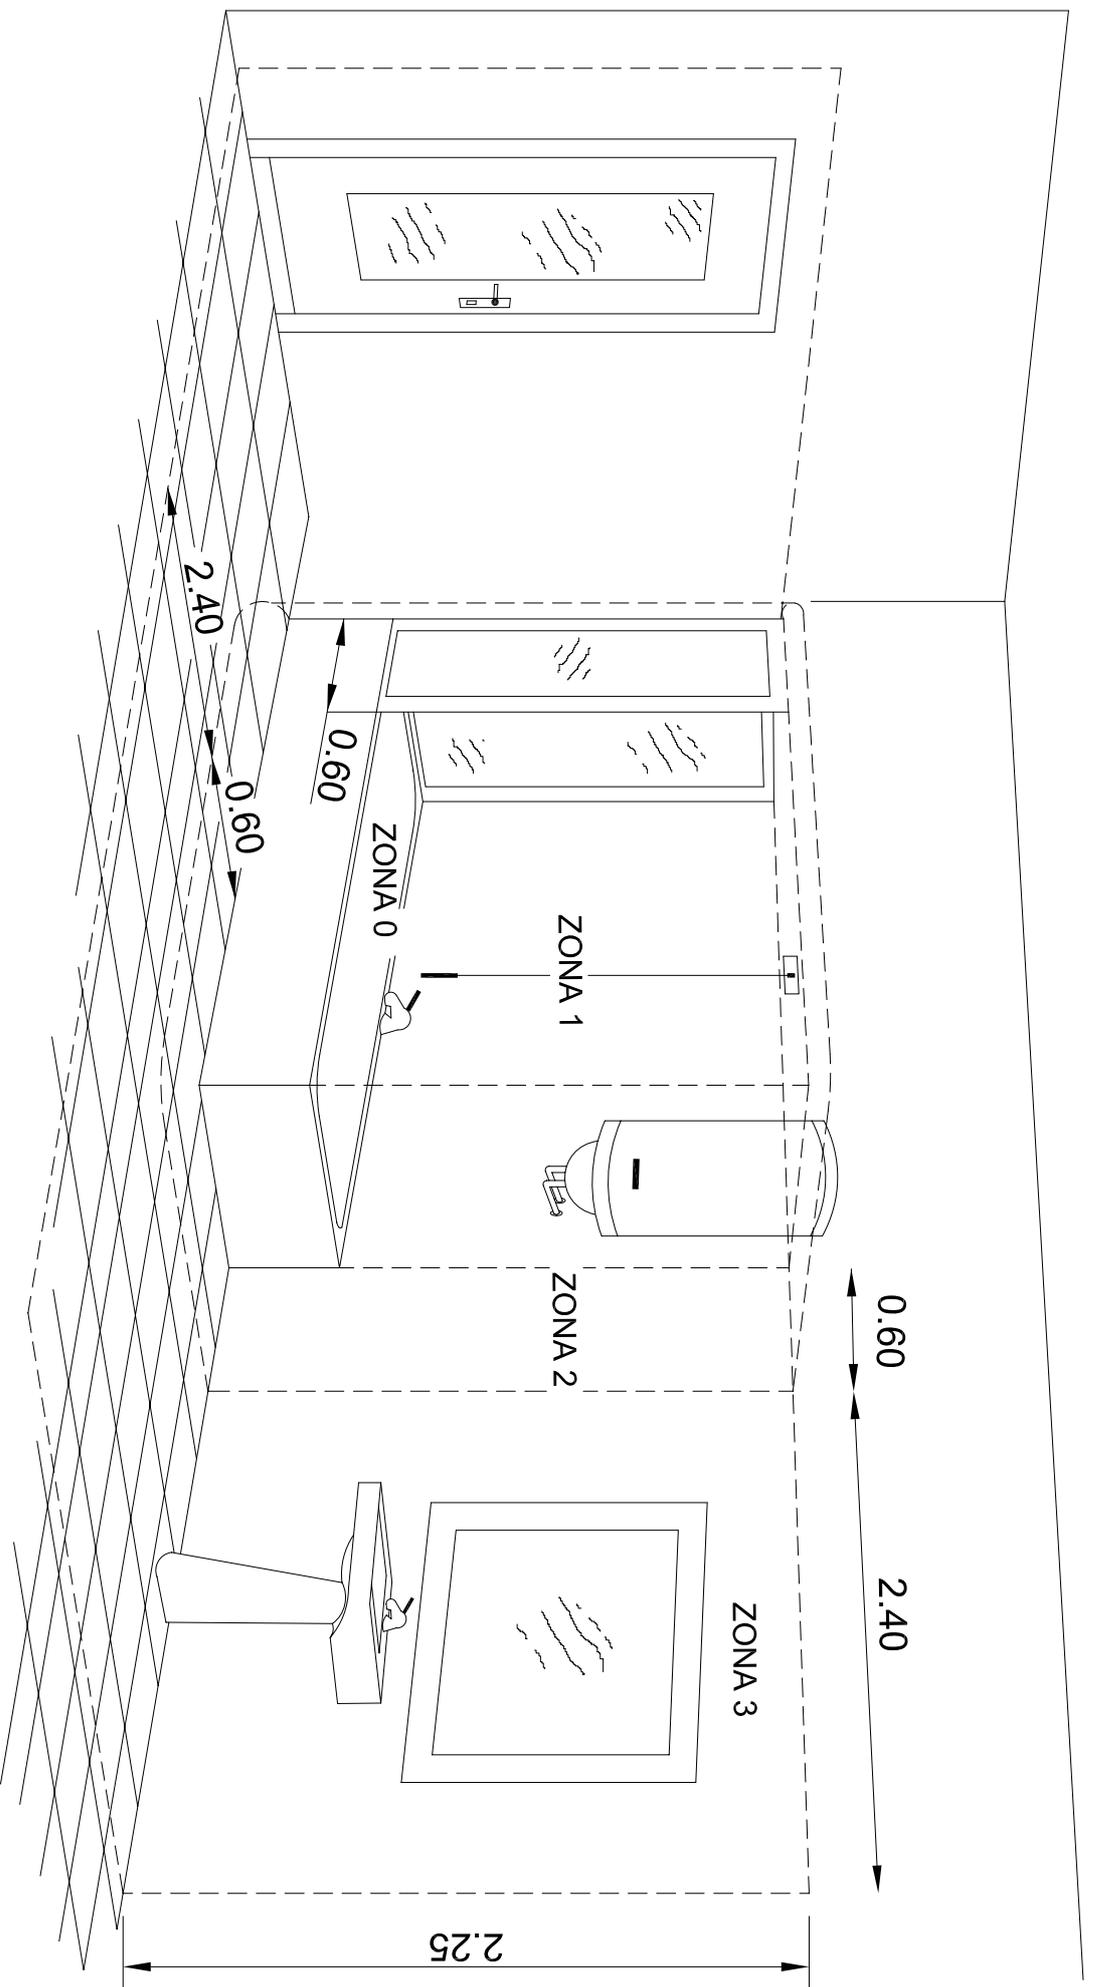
PARTICOLARE ALTEZZA DI INSTALLAZIONE PER GLI APPARECCHI DA INCASSO
